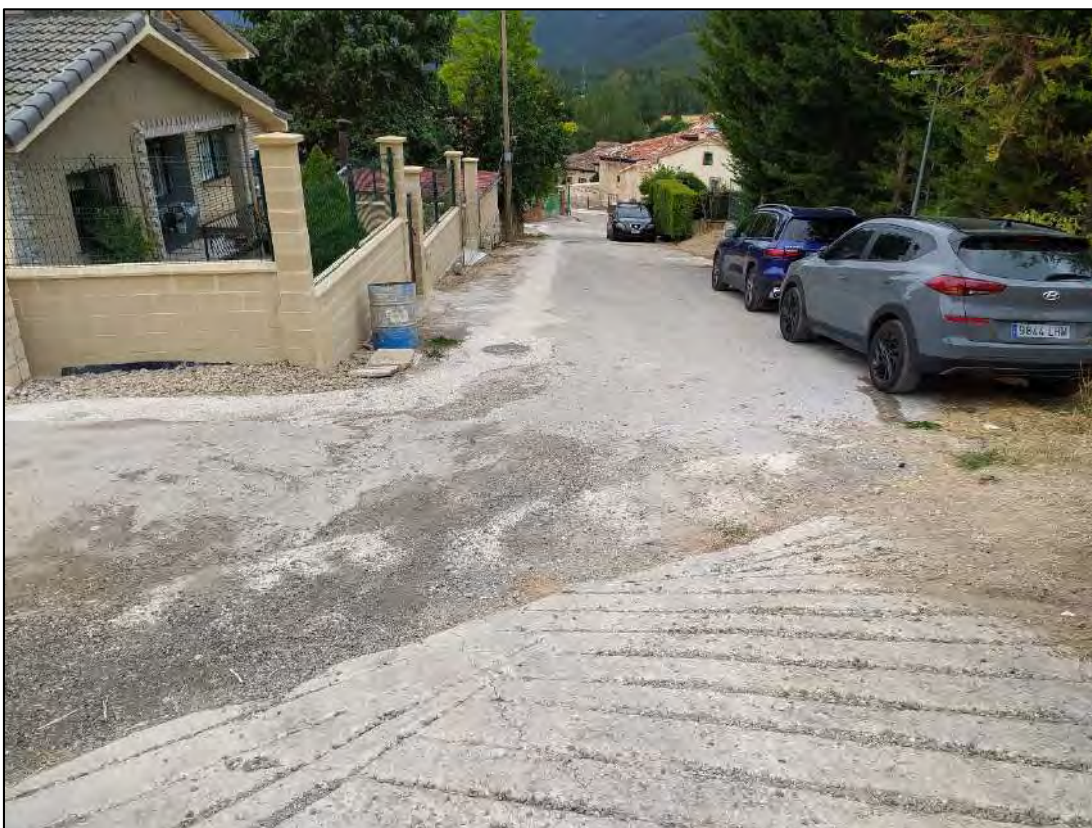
Calle La Cuesta. Final de tramo (Vista sentido descendente).
